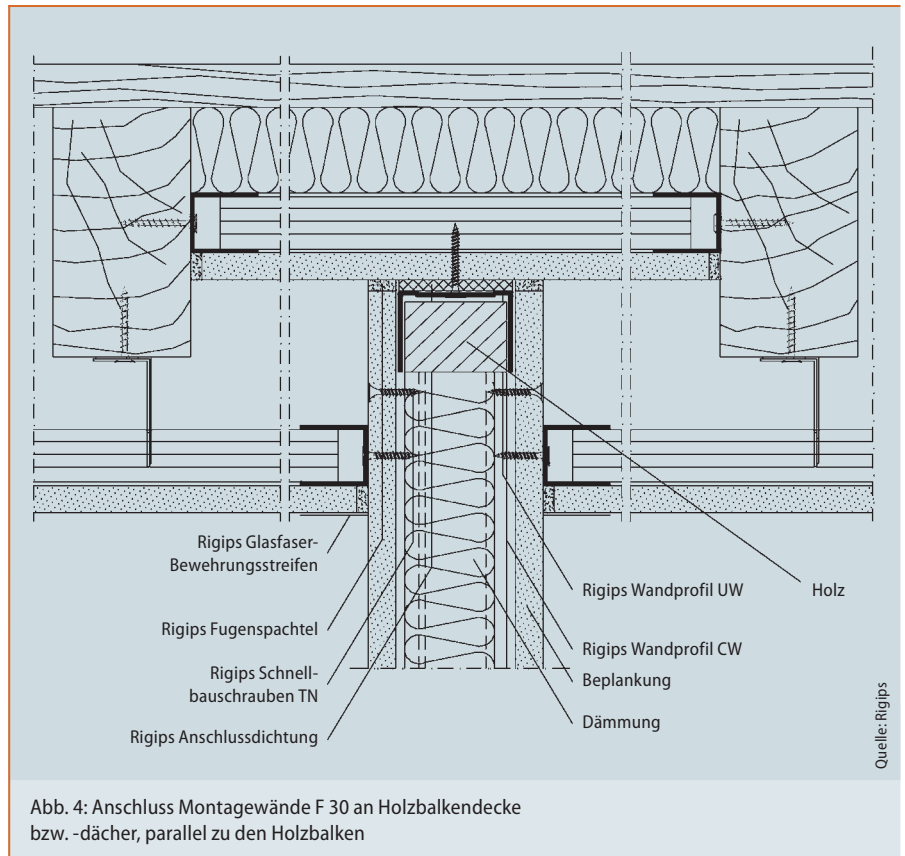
Anschluss Montagewände F 30 an Holzbalkendecke bzw. -dächer, parallel zu den Holzbalken
